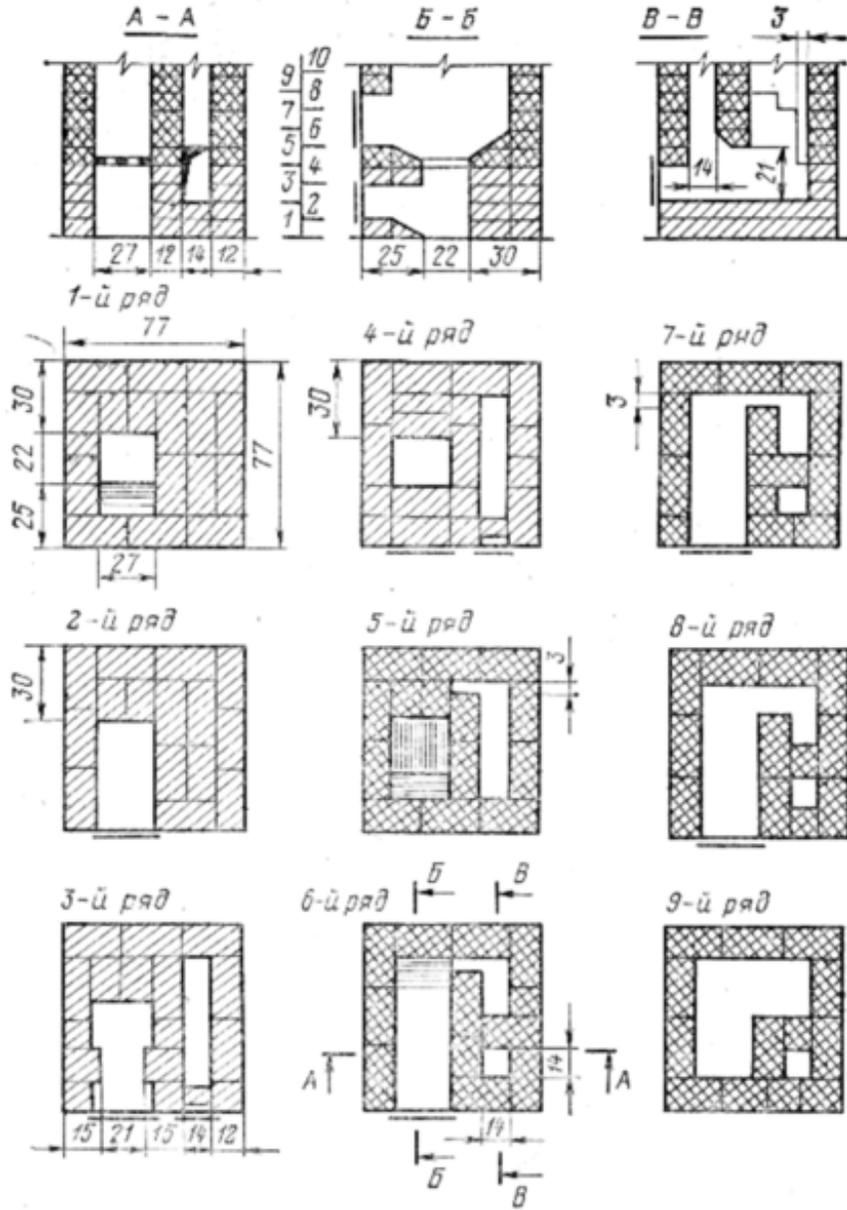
Кладки 1...9 рядов печи «Двухъярусный колпак» размером 77x77 см для дров. Остальные ряды выкладывают по чертежу печи для угля: по 14-й ряд включительно из огнеупорного кирпича, а выше — из красного кирпича. (Размеры в см)
